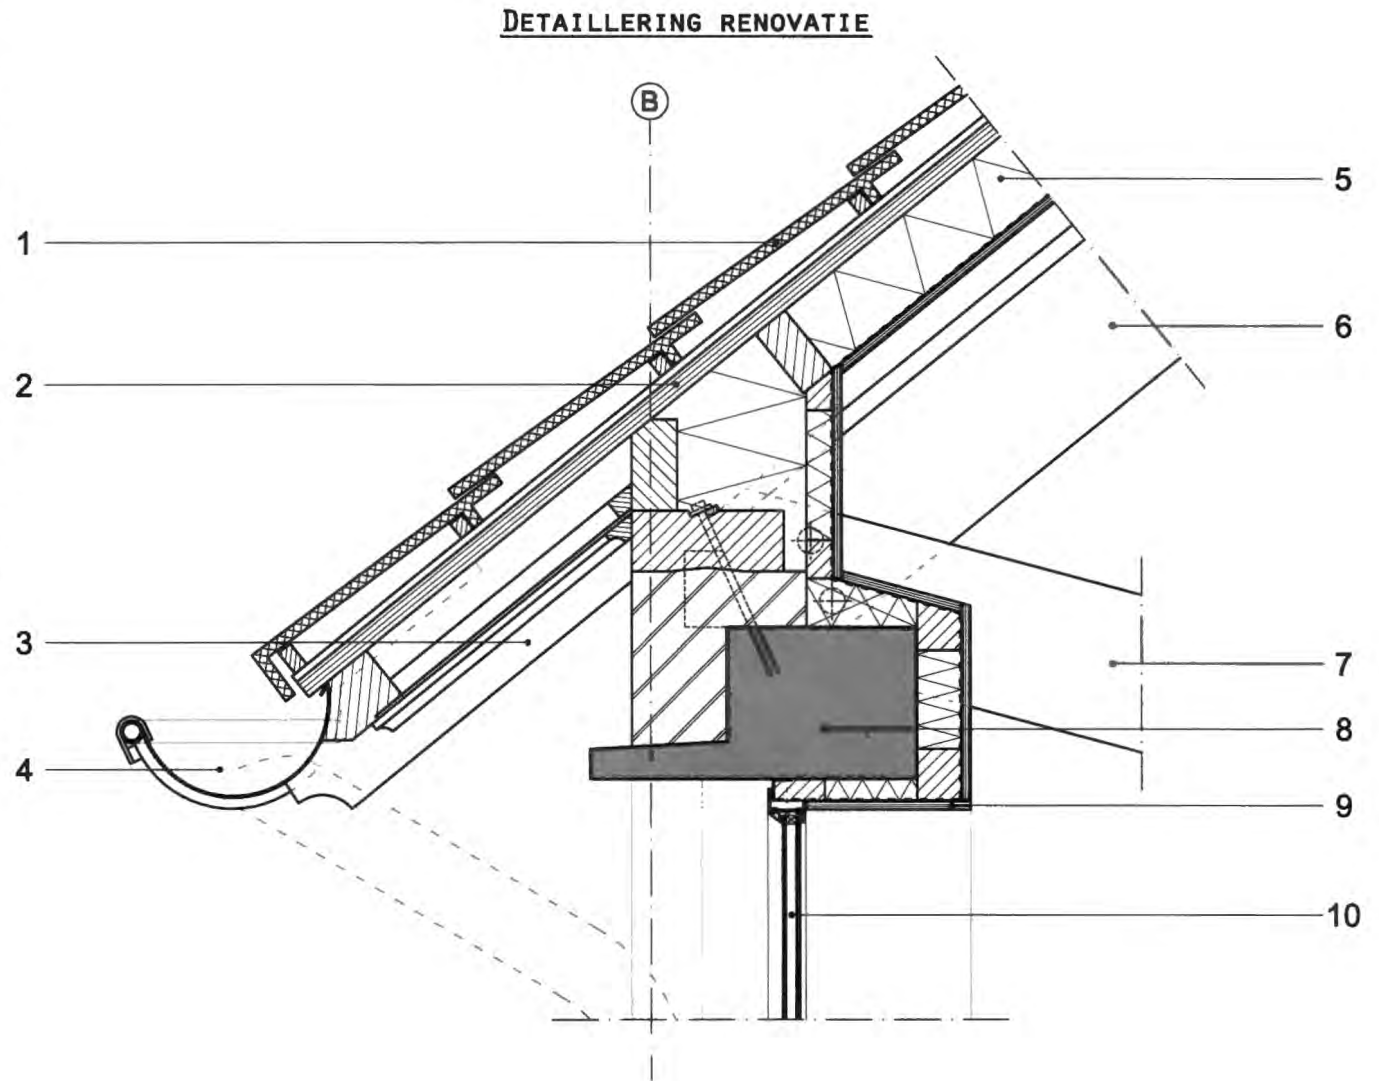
BOVENZIJDIGE GEVELOPENING 2<sup>E</sup> VERDIEPING
